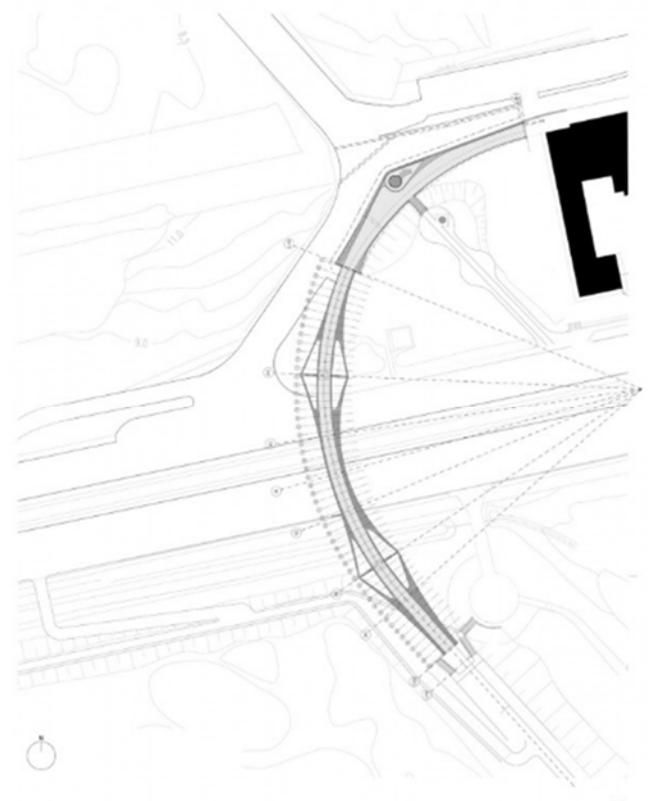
Lageplan: Knokke-Heist Footbridge, Belgium
